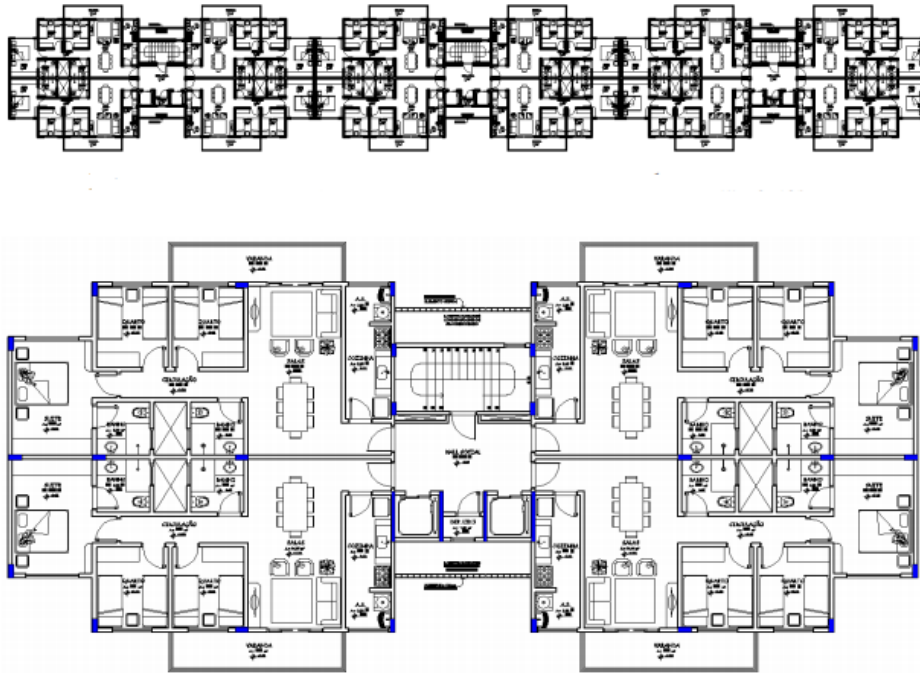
Planta baixa do edifício e do bloco germinado (MACIEL, 2013)
